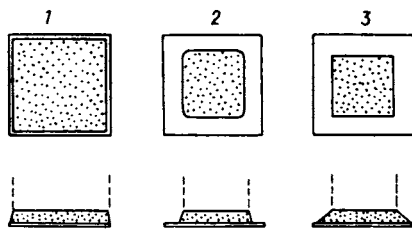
Нанесение строительного раствора на облицовочные плитки
